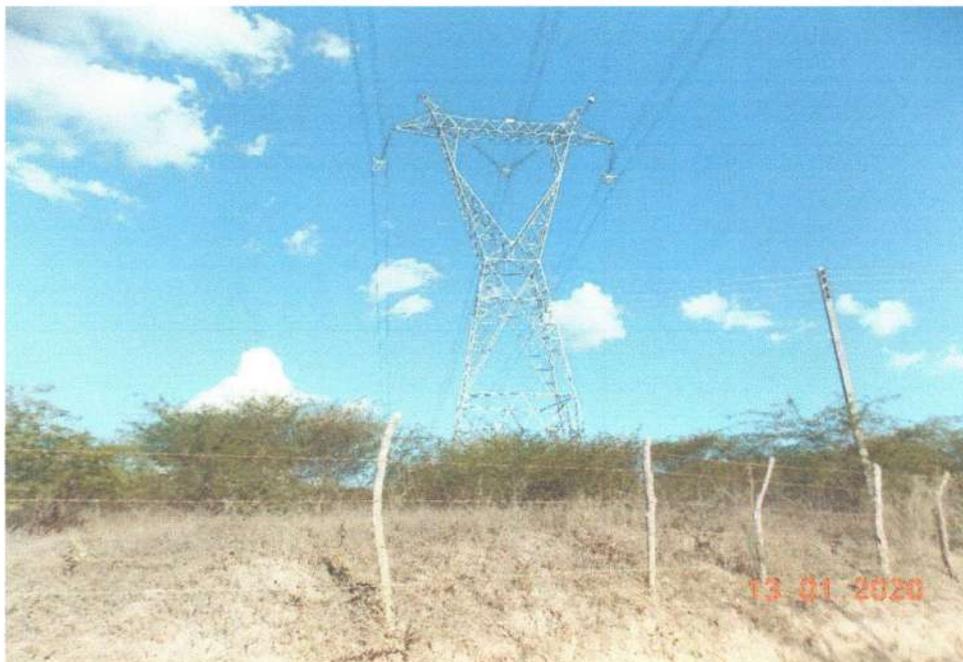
Linha de Transmissão de 230 kV da CHESF na área do terreno onde será implantado o empreendimento. FONTE: Alúcio Sales, 2020.
